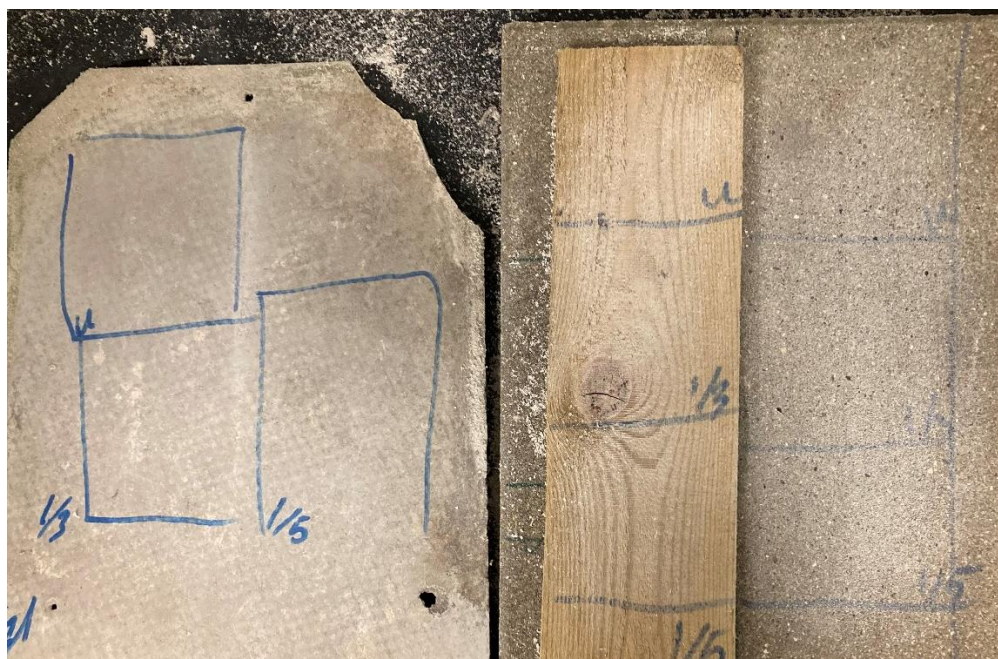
Asbestfibre er masseret ned i overfladen og støvsuget.
